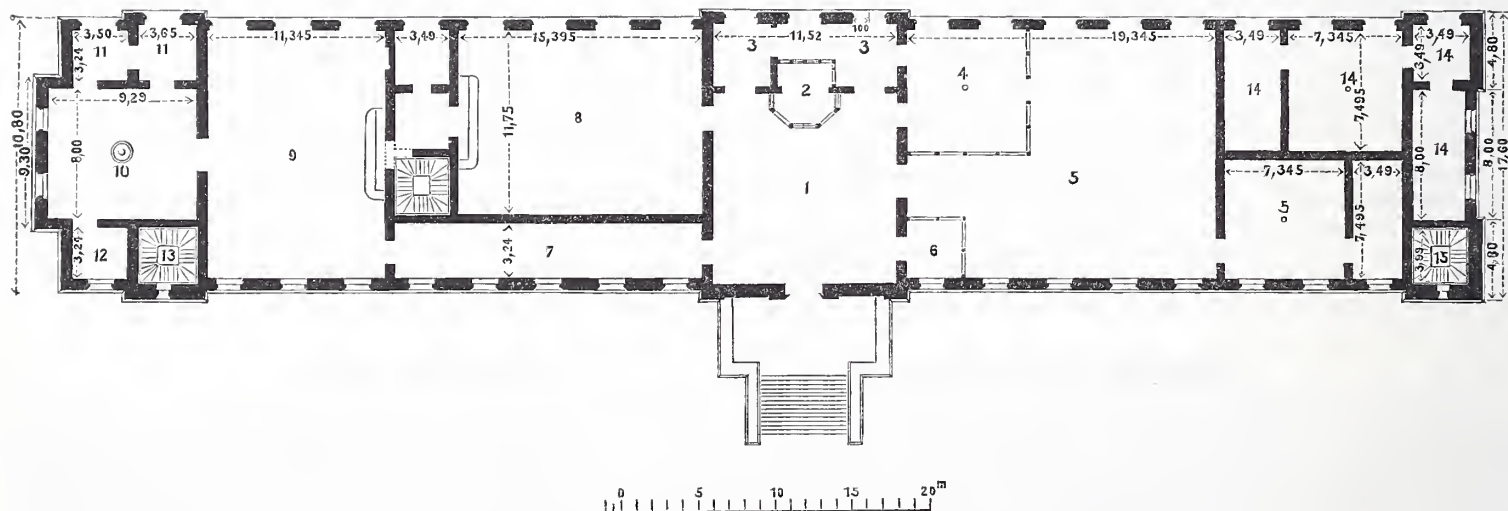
Grundriss vom Erdgeschoss.
